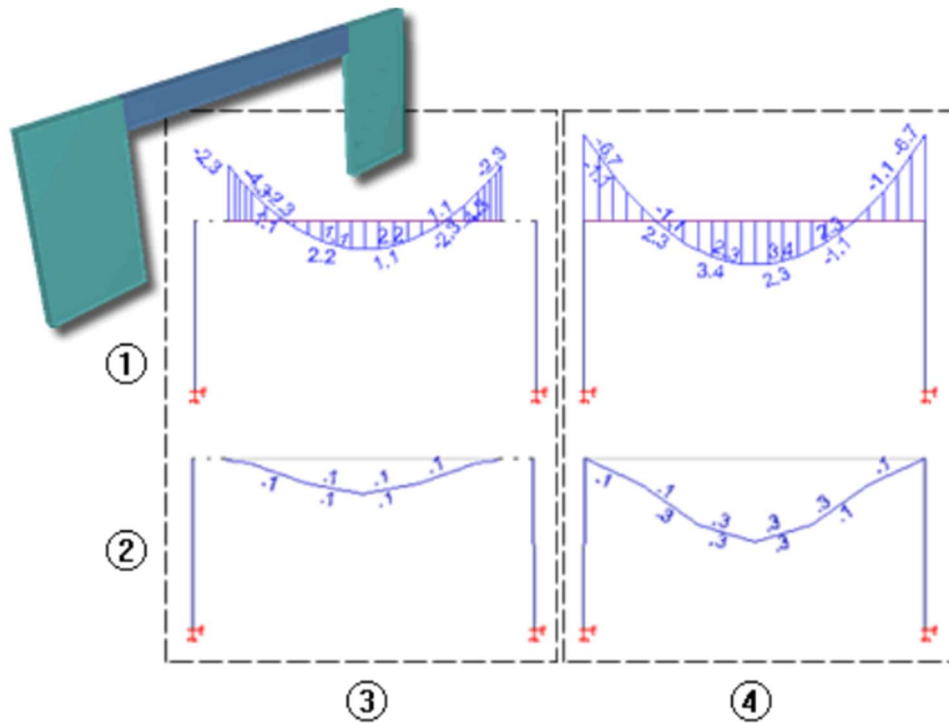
Comparação entre a aplicação de cargas de alvenaria no TQS e no RSA, respectivamente.
